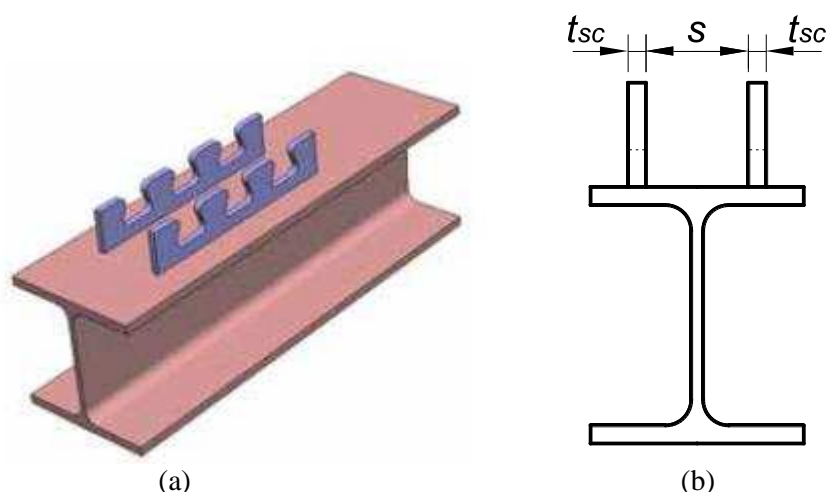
(a) Utilização de conectores Crestbond em paralelo (VERÍSSIMO, 2007); (b) espaçamento entre conectores Crestbond em paralelo.
